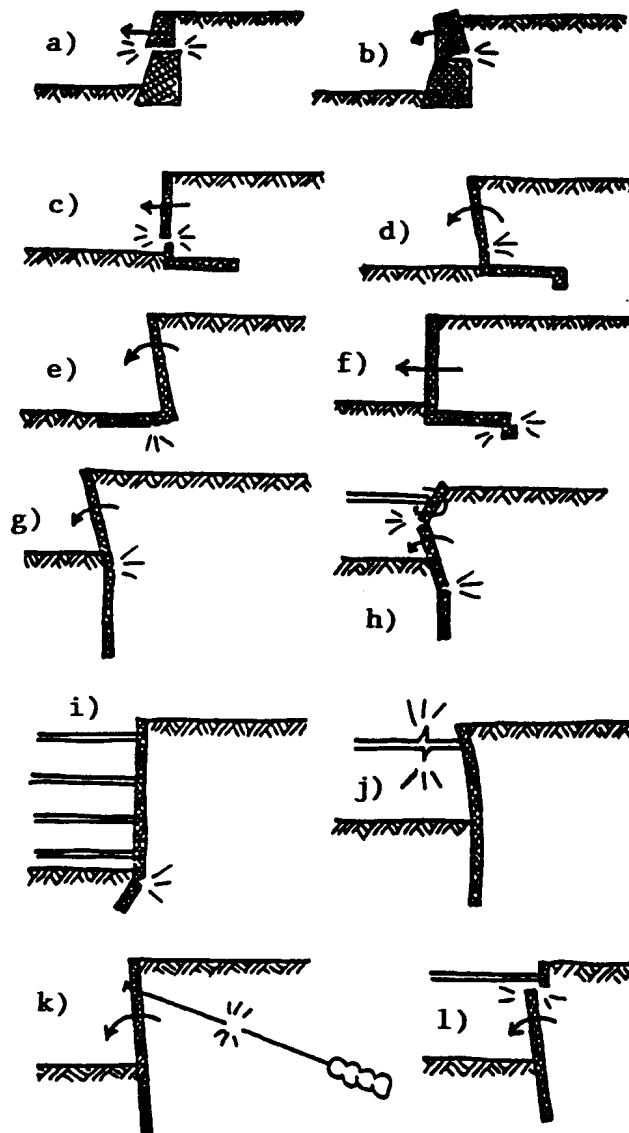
Ejemplos de situaciones límites para la rotura estructural de las estructuras de contención
